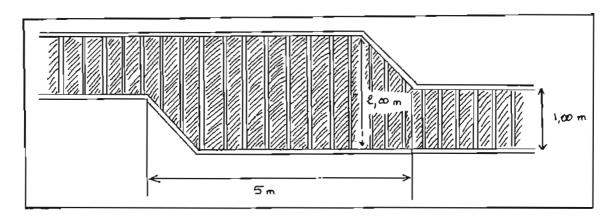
Chicane de croisement sur platelage d'accès (autre type)
